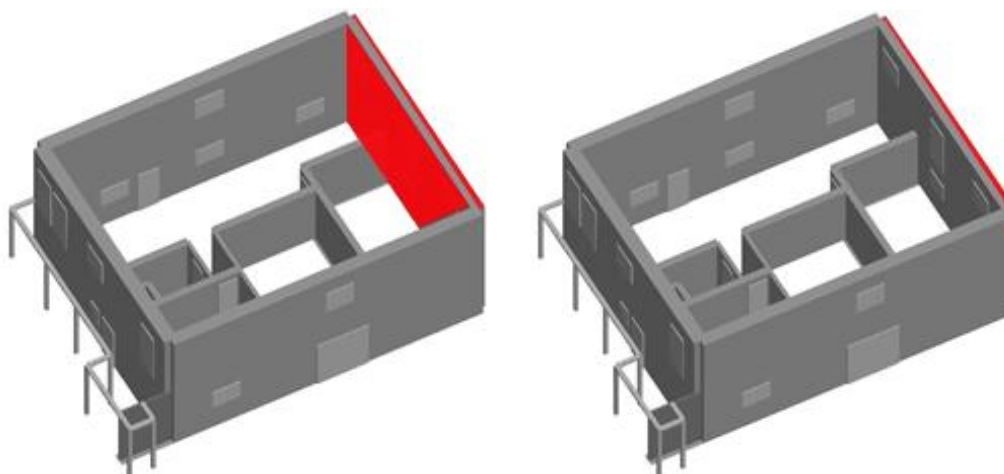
Comparação da execução de reboco armado nas duas faces da fachada principal com execução de reboco armado numa face da mesma fachada
